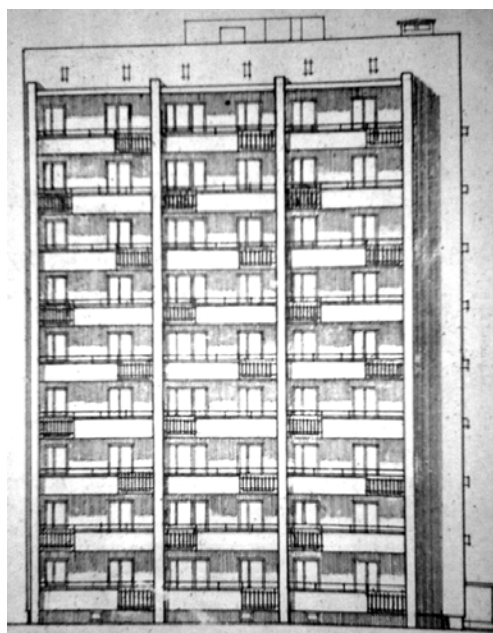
Вариант фасада дома с перекрытиями лоджий на отметках перекрытия квартир
